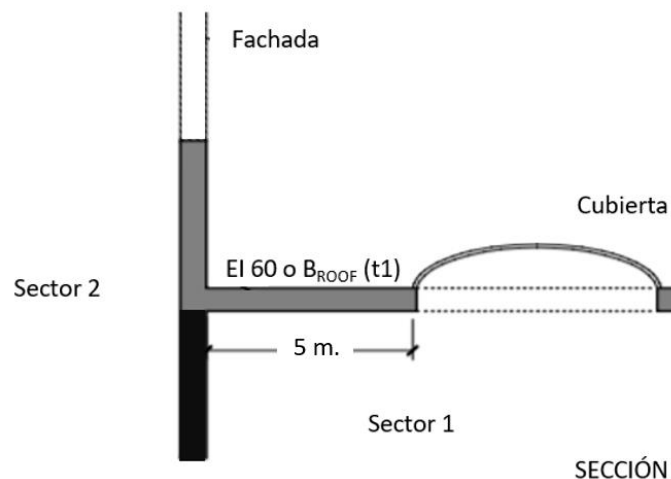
Resistencia o reacción al fuego de la cubierta, en el encuentro cubierta-fachada.
